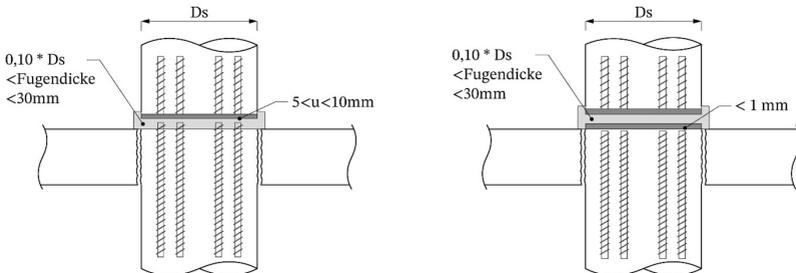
Kraftdurchleitung im Deckenbereich bei Stützen mit hochfestem Bewehrungsstahl
